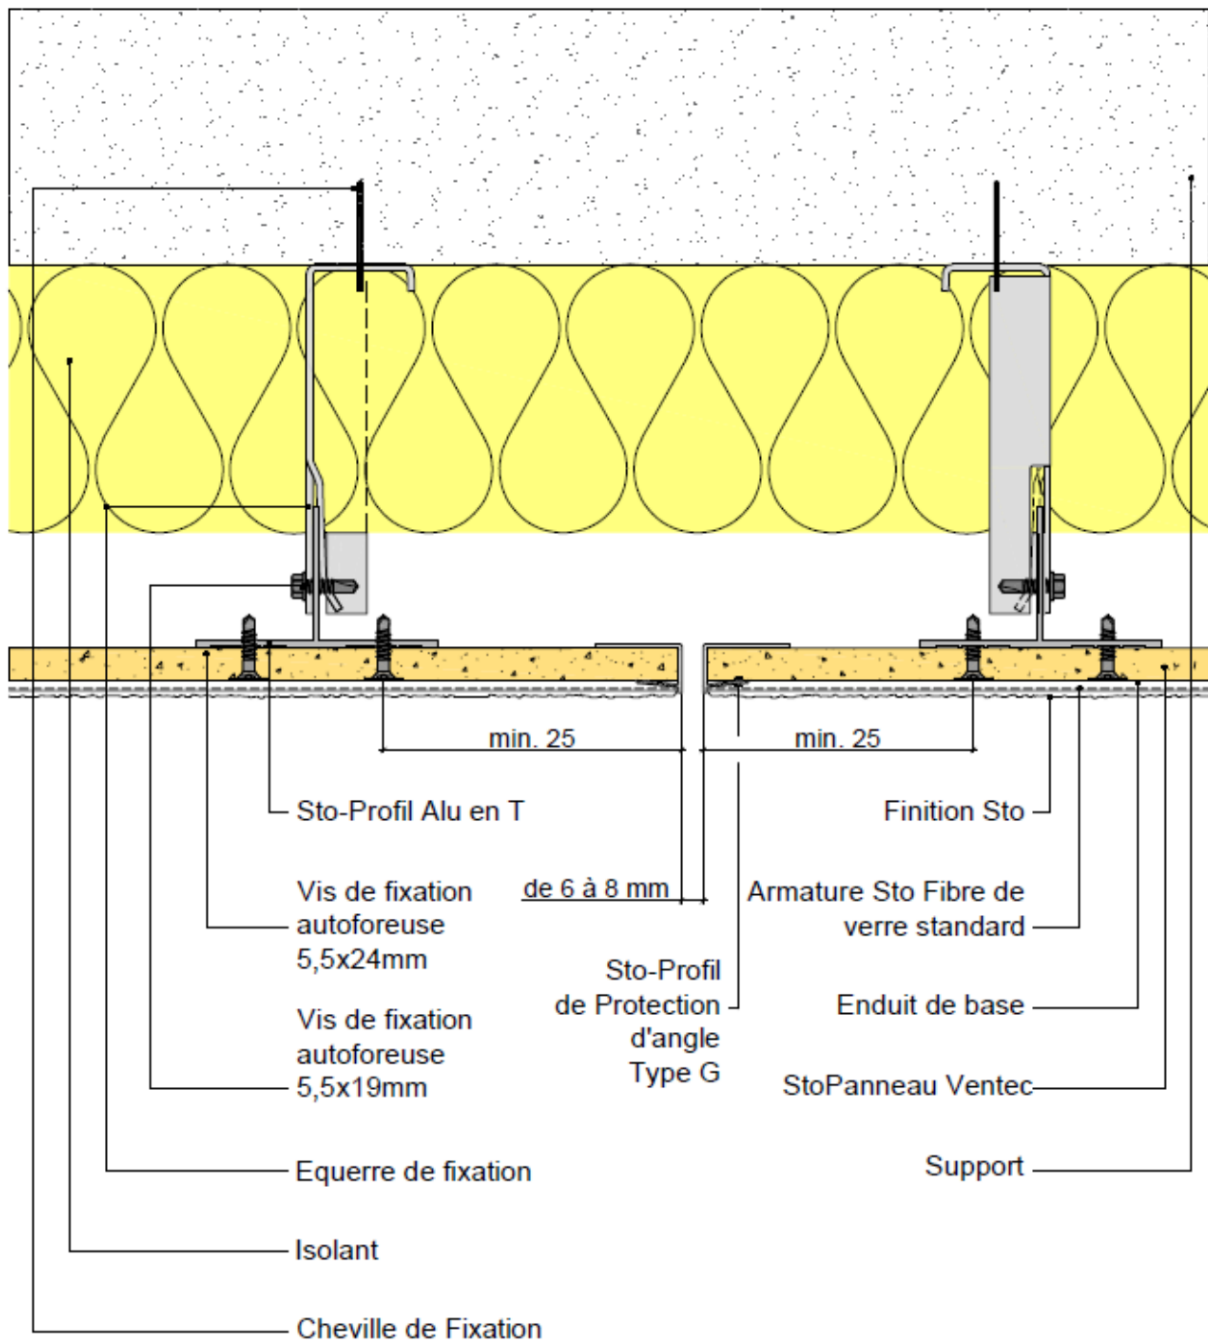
Coupe horizontale - Fractionnement à joint ouvert - Ossature aluminium
